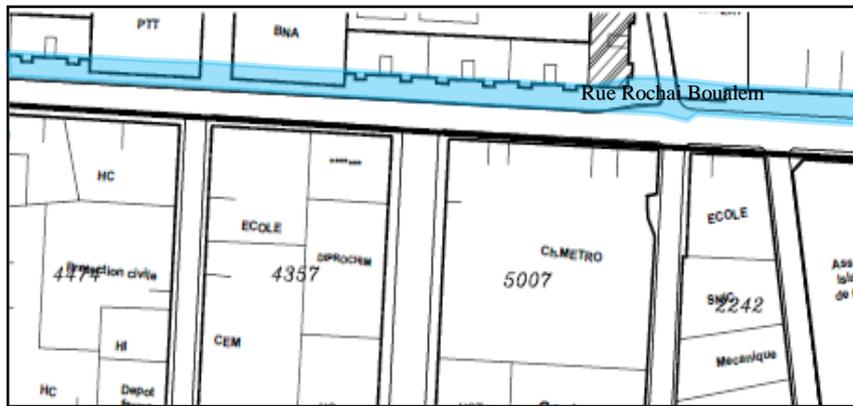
vue en plan de la rue Rochai Boualem avant l'intervention
